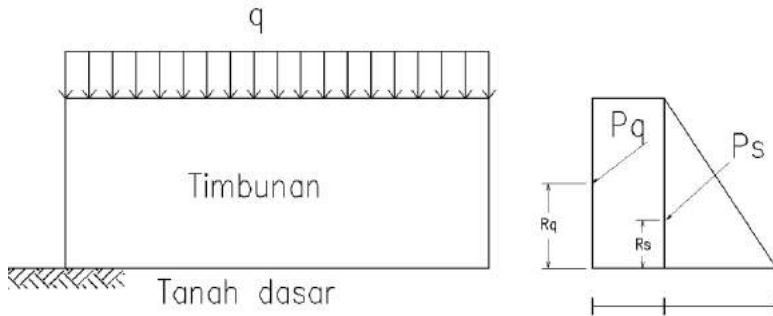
Sketsa Perkuatan *Geotextile wall* pada Timbunan BH-1
